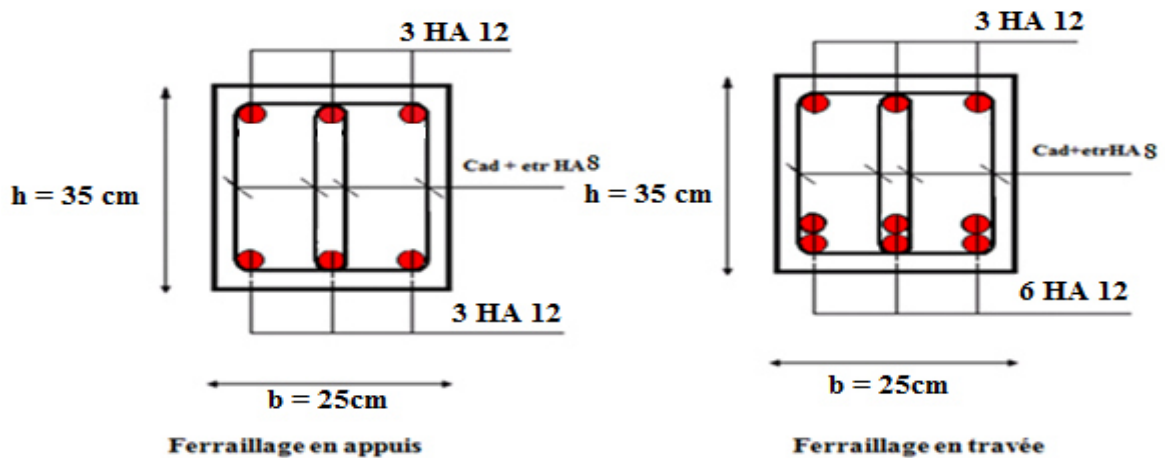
Schéma du ferrailage de la poutre palier.
